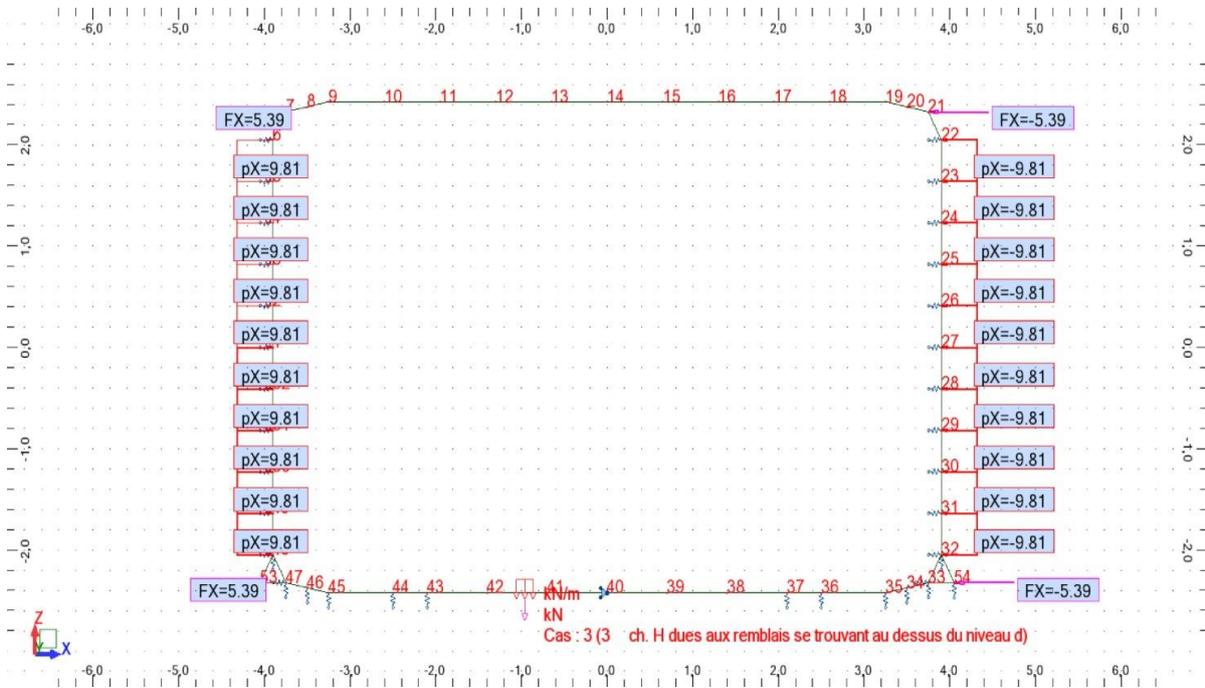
Cas 05 ch. H dues aux remblais se trouvant au-dessus du niveau de la dalle
